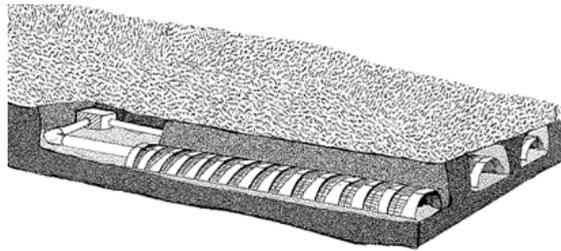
Cámara de infiltración (Fuente: Hoover, 2013).
